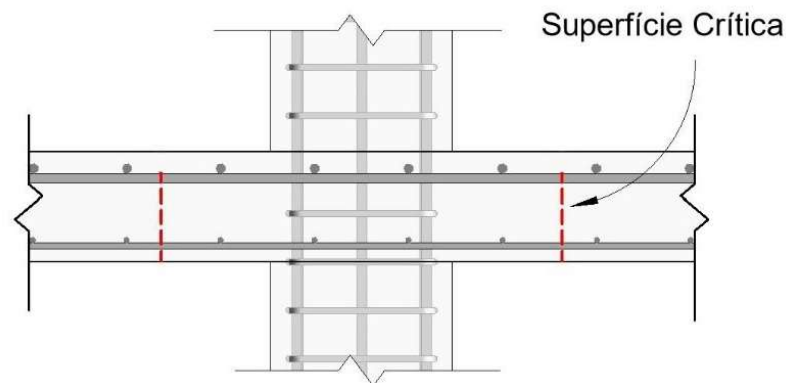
Detalhe superfície crítica em lajes lisas
